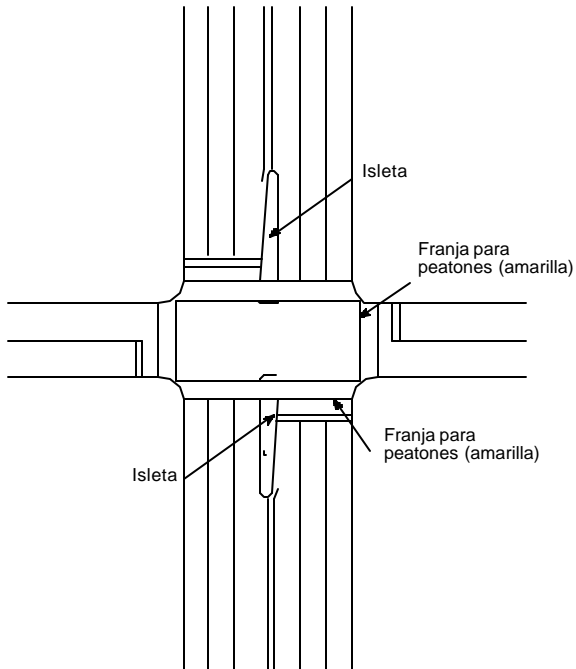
Isleta de refugio con una faja al nivel del pavimento, situadas en el eje de una avenida.
